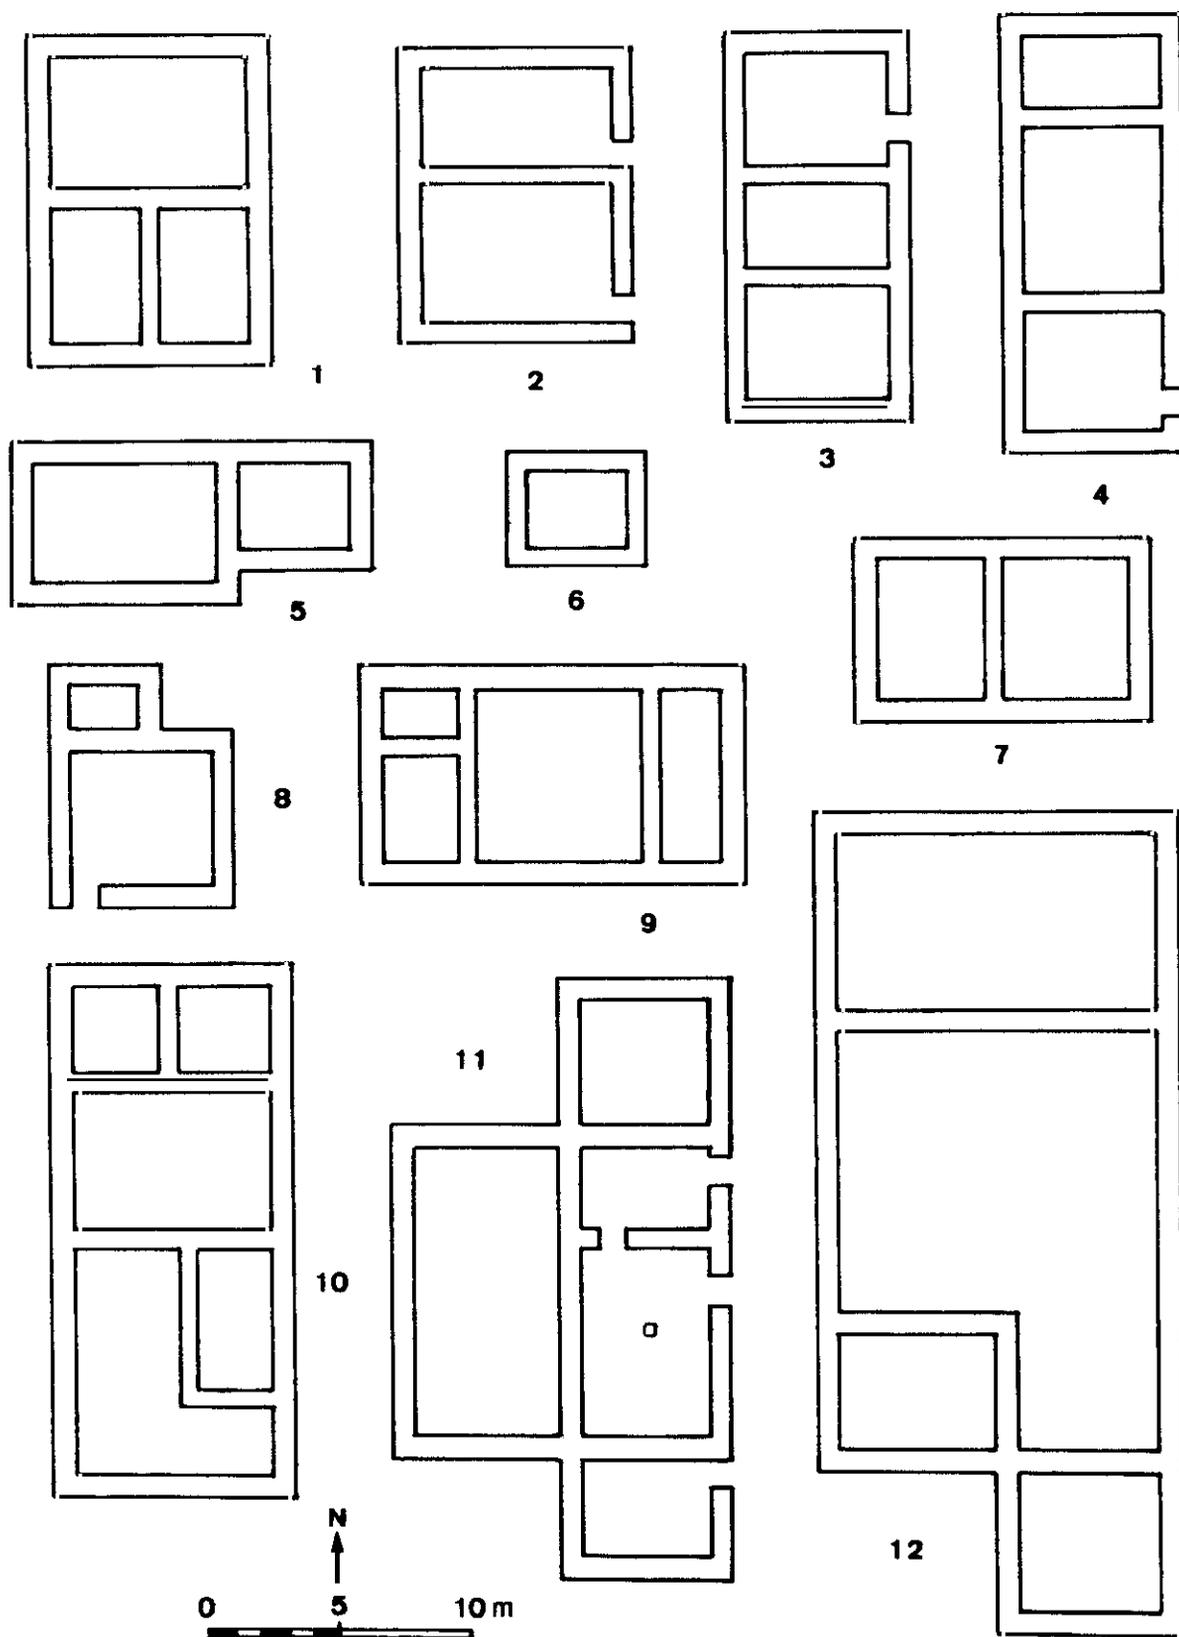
Croquis de las plantas del castro de Ulaca, Solosancho (Avila).
